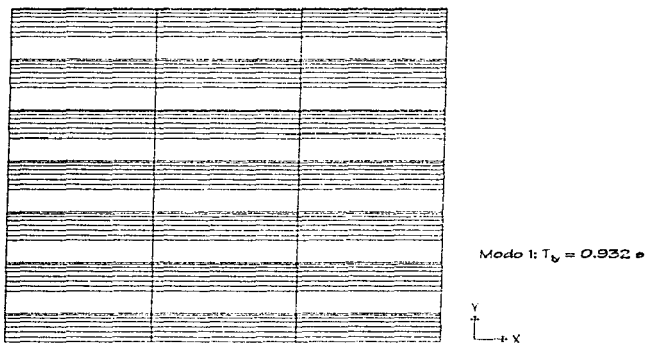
Vista en planta del modo fundamental de vibración en dirección "Y" (similar en la dirección "X"), estructura de 7 niveles diseñada en zona III
